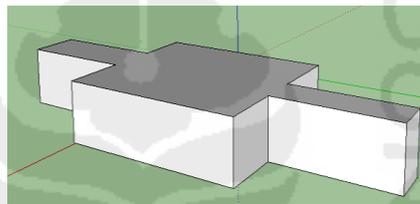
Konsep Bangunan dan Jalan Eksisting Awal
